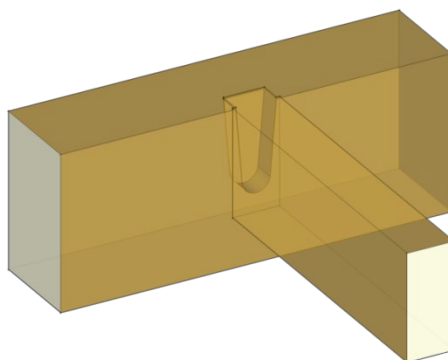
Prinzipskizzen zu Kontaktanschlüssen
